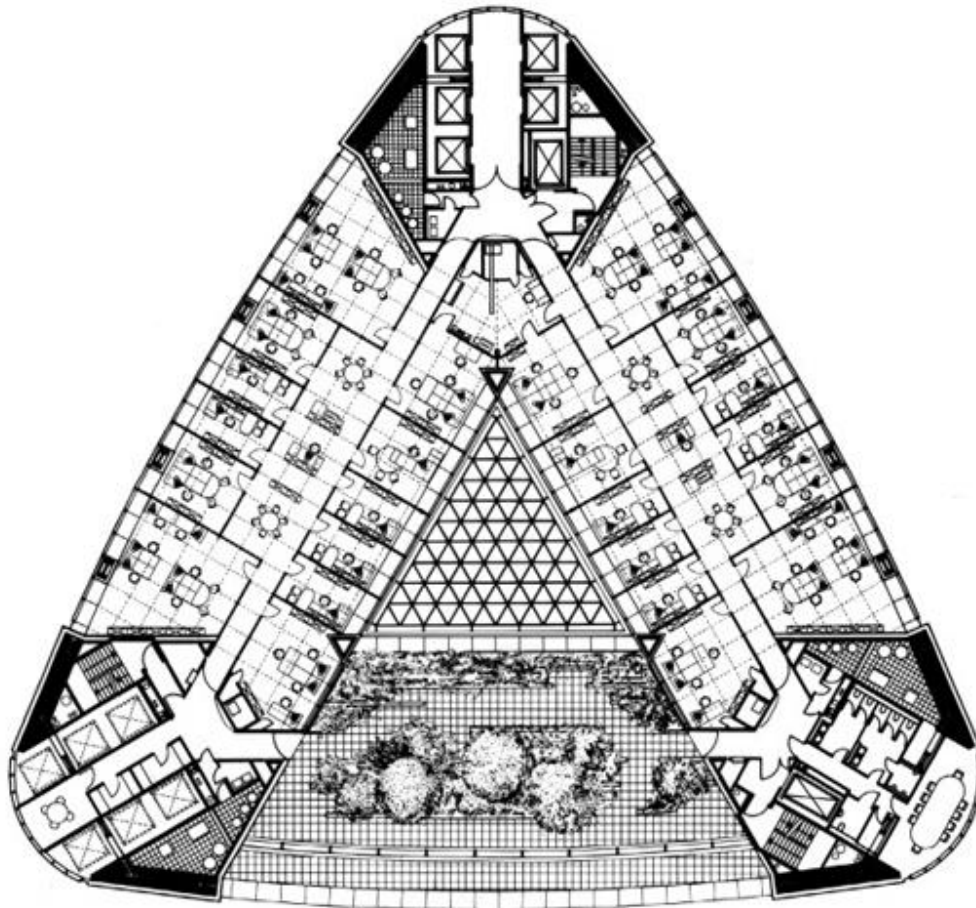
Grundriss des Commerzbanktowers in Frankfurt am Main
